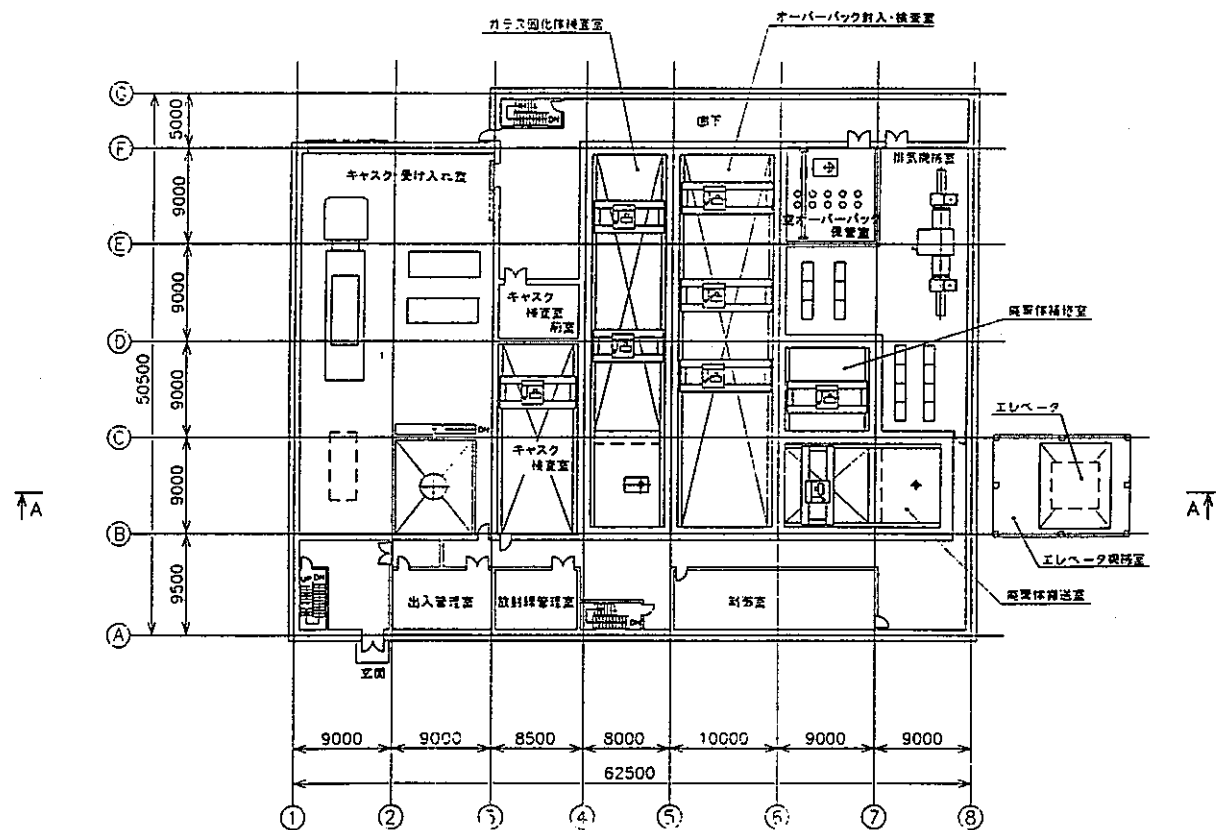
(2/4) 地上施設：廃棄物受け入れ・検査施設機器配置図（1階平面図）
